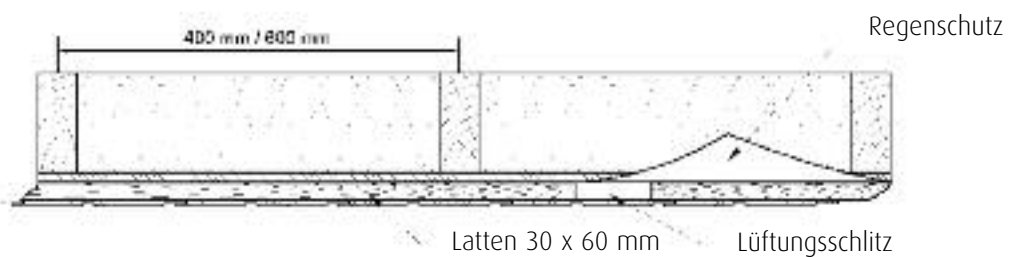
Senkrechte Montage der Ultra-Plank / Ridgewood Fassadenelemente
